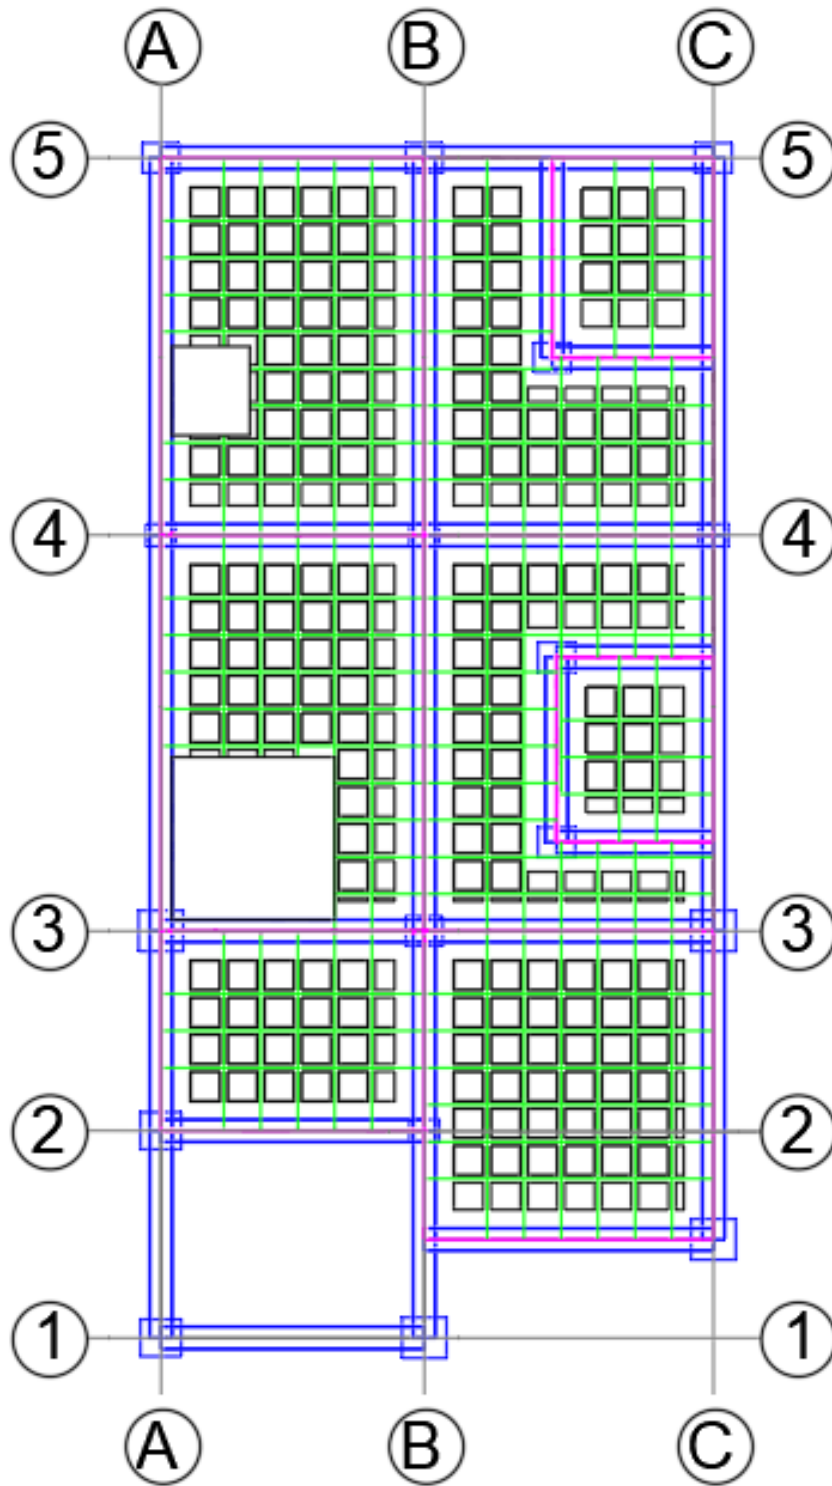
Distribución de Losa Nervada pisos 1, 2 y 3. Fuente: Nicolás Pozo
